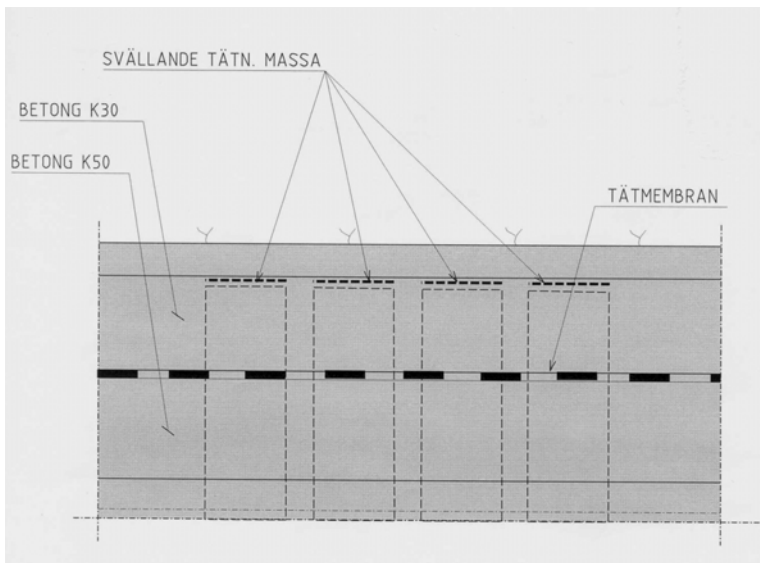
Projekt Hallandsås, Platsgjuten betonginklädnad. Rörelsefog mellan monoliter.
